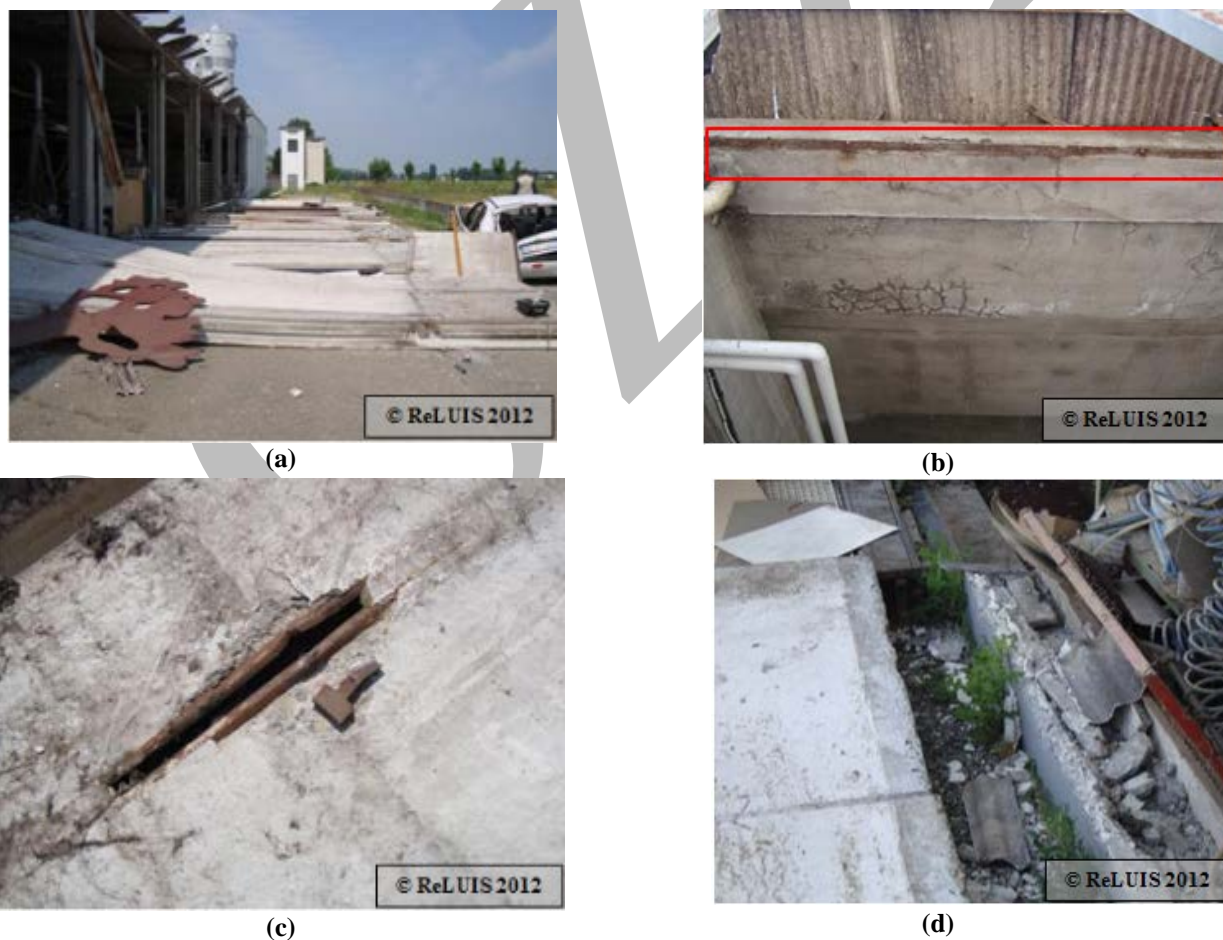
(a) Crollo dei pannelli verticali di tamponamento: (b) dettagli profilo di acciaio saldato sotto la trave, (c) dettaglio connettore in acciaio saldato sulla piastra saldata alla trave ed inserito nel profilo incavo del pannello tramite la testa a martello e (d) trave reggipannello
